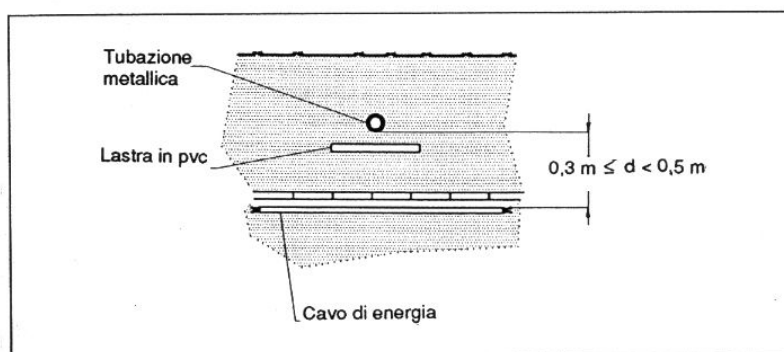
Se il cavo di energia dista dalla tubazione metallica meno di 0,5 m, occorre un elemento separatore non metallico.
